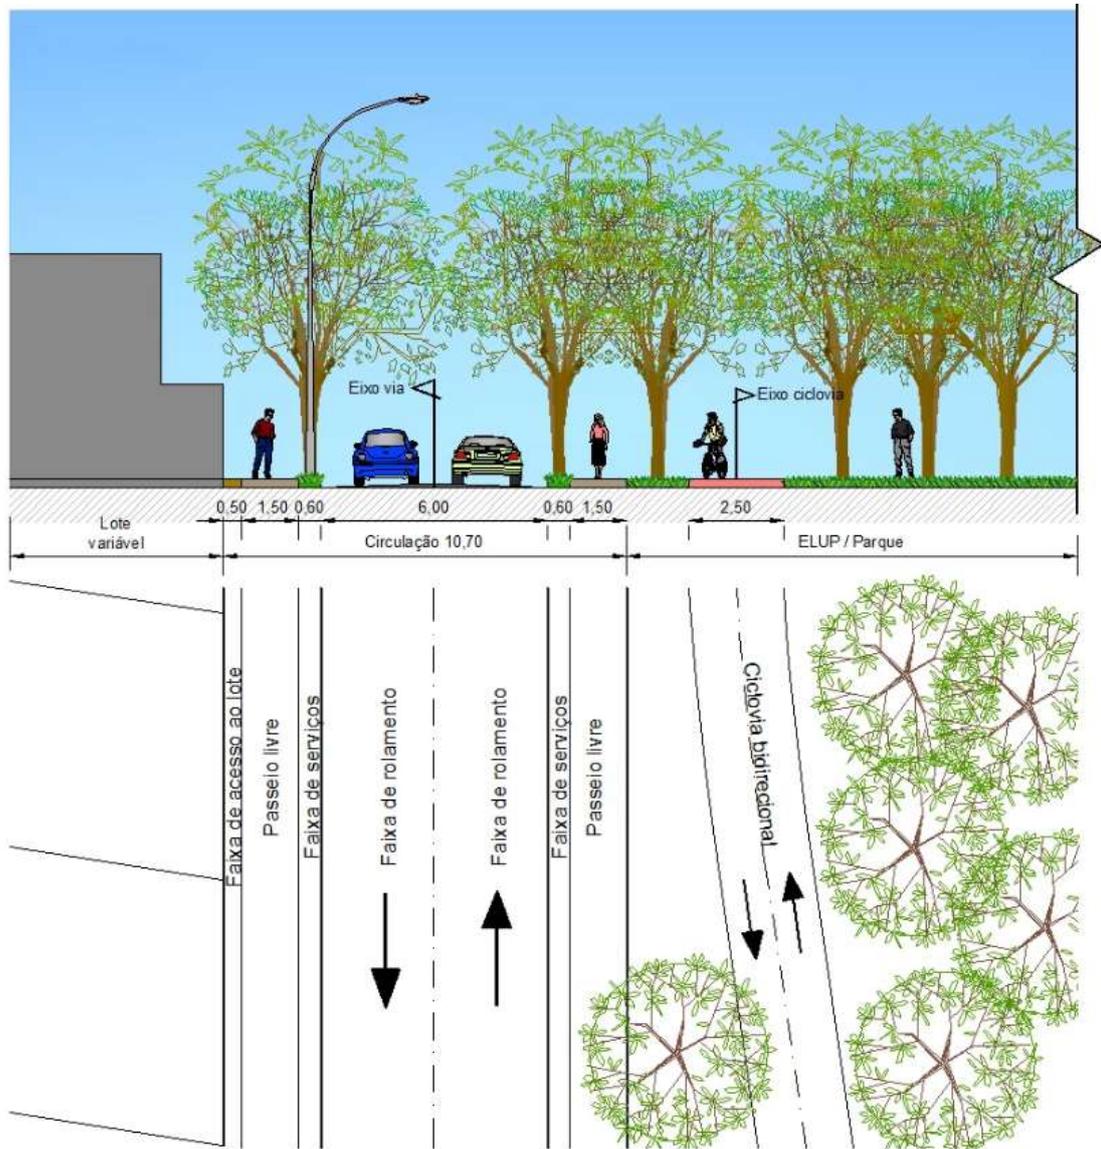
Perfil da Rua Parque (Perfil 02 no croqui)
